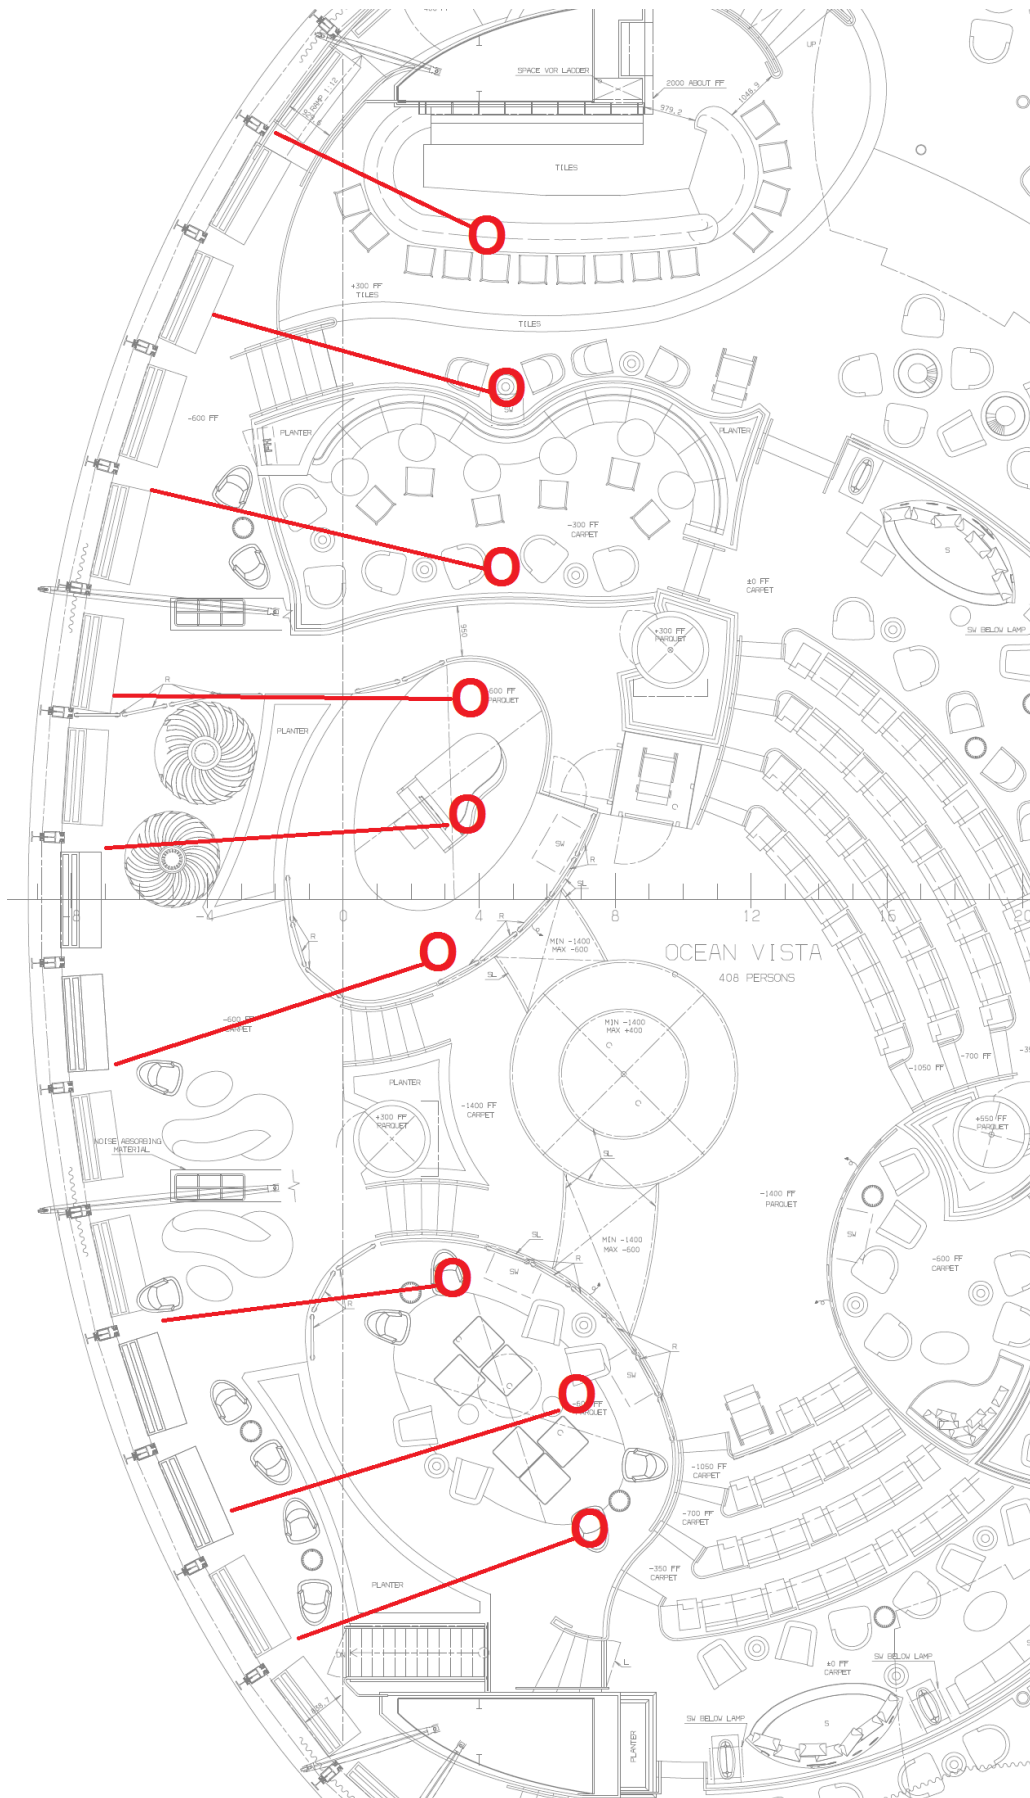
Messpositionen im Two70° Grundriss
